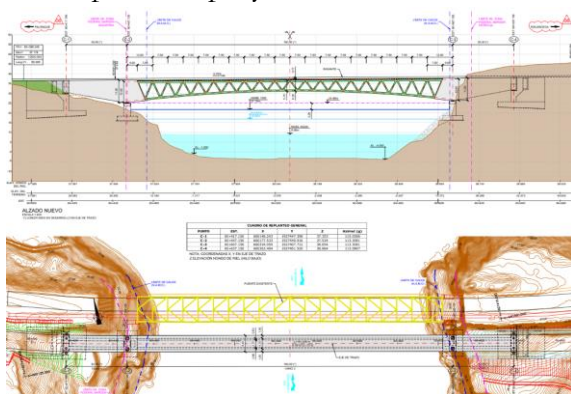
Perfil longitudinal y planta del nuevo puente Boca del cerro.
